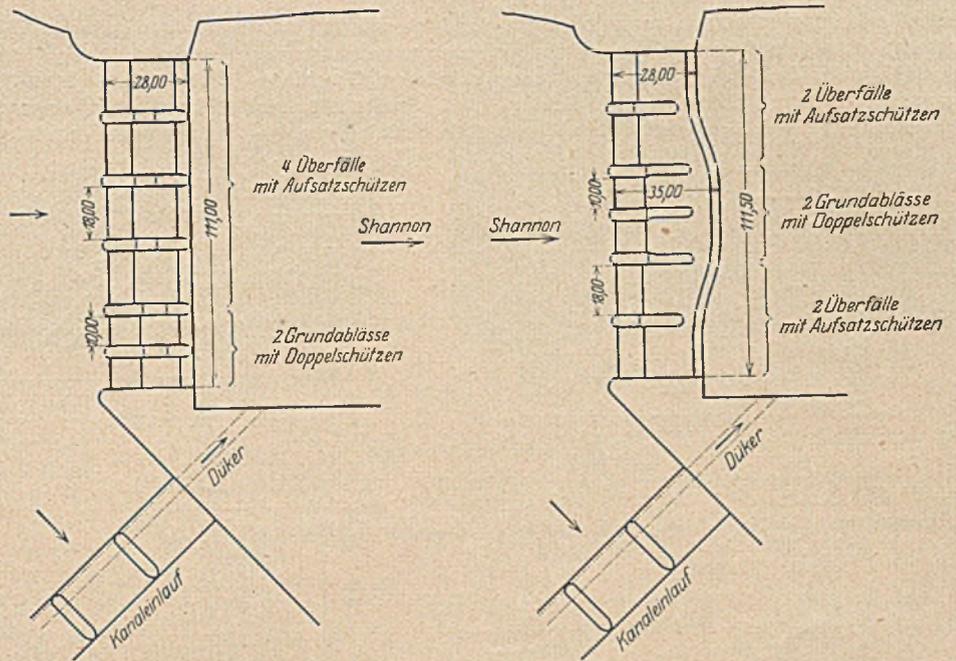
Grundriß des ursprünglichen Bauentwurfes.
